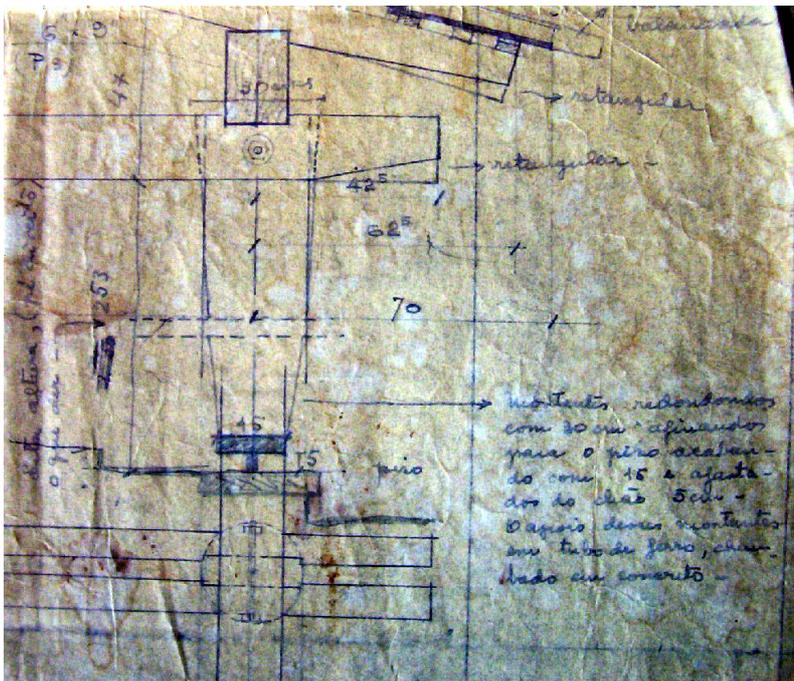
Trecho da planta de detalhamento do telhado e colunas dos claustros. (Fonte: Arquivo MNSG).
